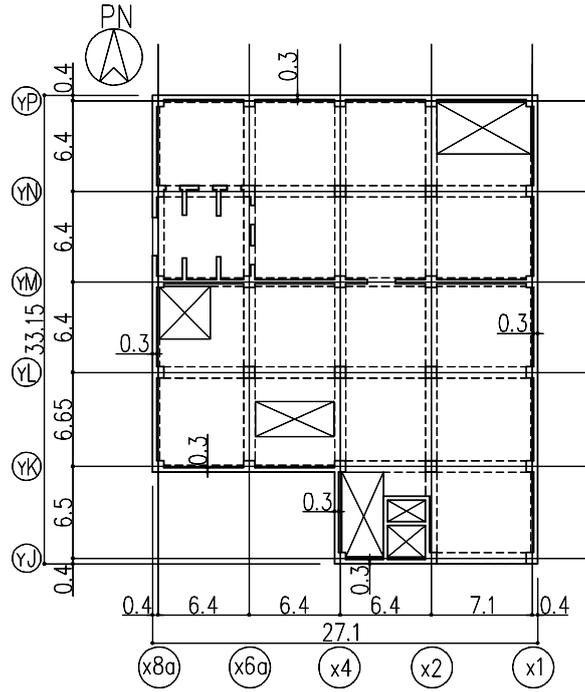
地上2階平面図 (G.L.+4.7) (单位:m)
